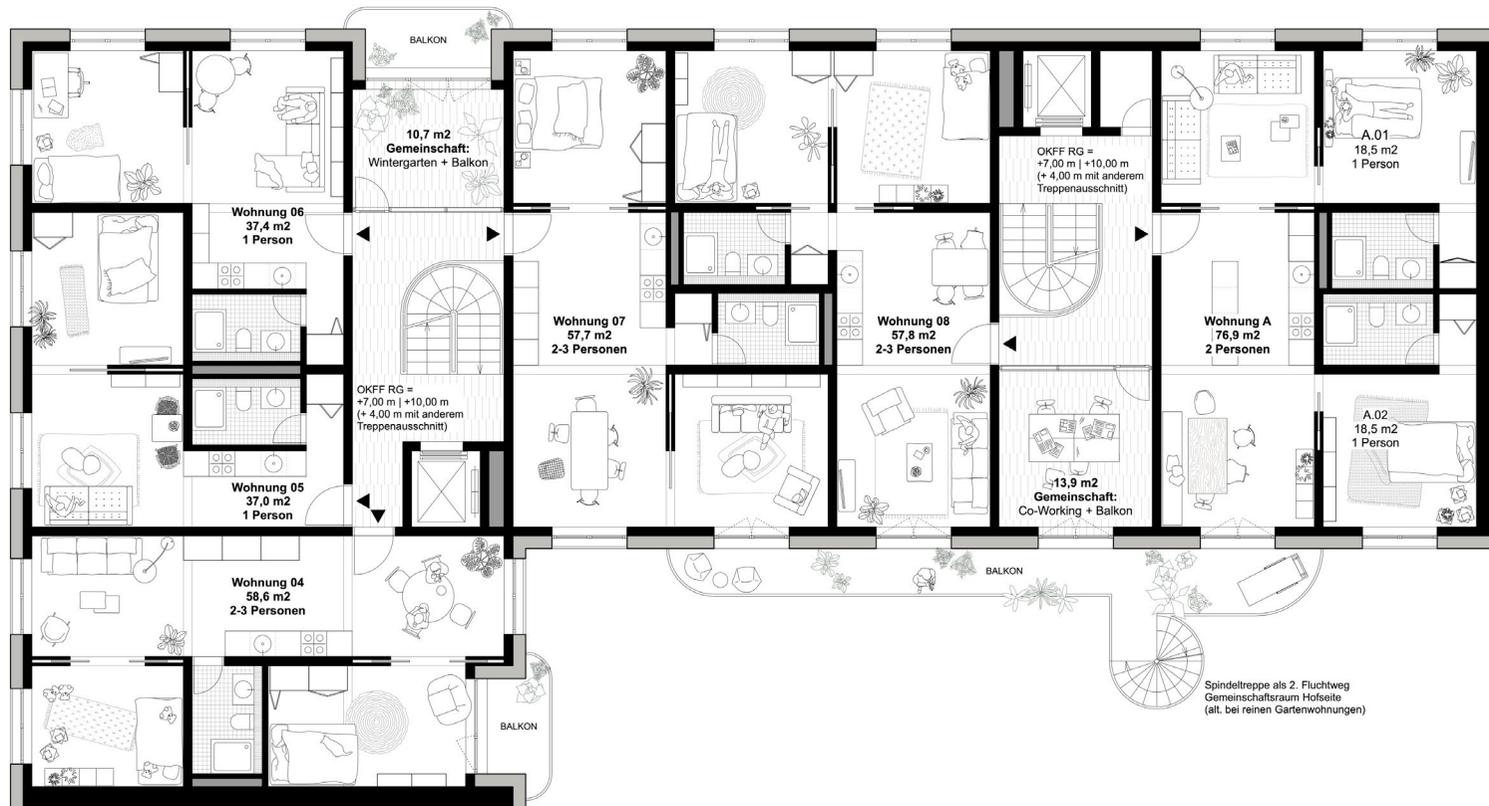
Regelgeschoss | M 1:175 | Kirsten Schemel Architekten BDA (Berlin)
